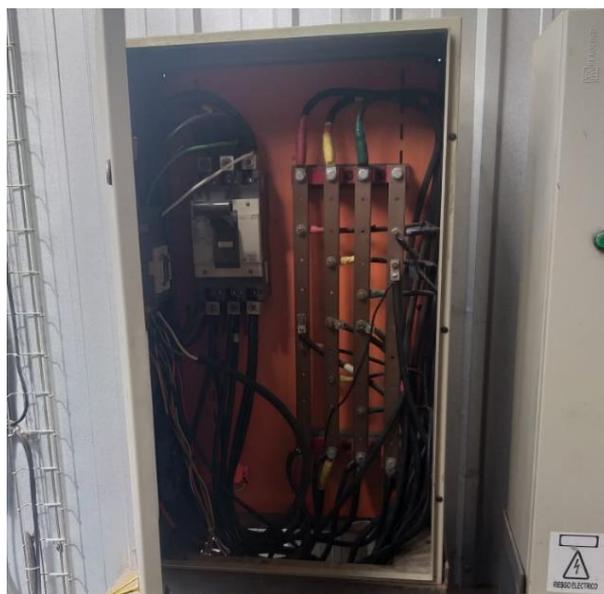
Tablero central de la planta PISAMDE S.A.
